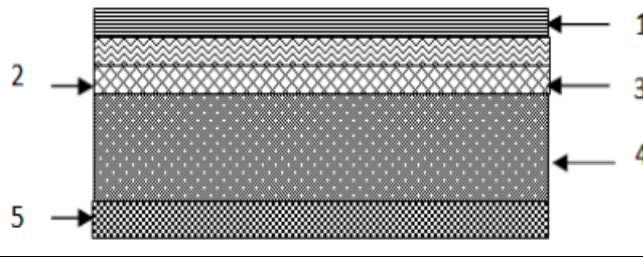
Coupe verticale de plancher sous-sols en dalle pleine.
